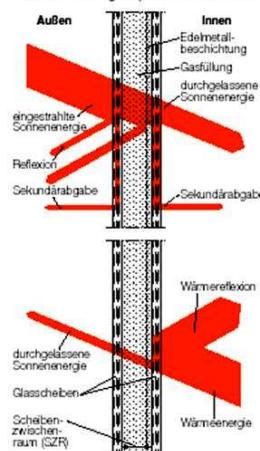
Wärmedurchgang durch ein Fenster mit Wärmeschutzglas (schematische Darstellung)
